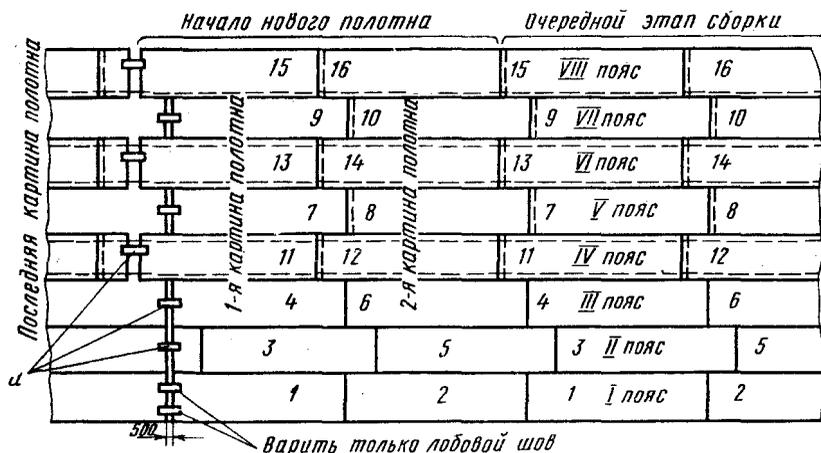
Схема сборки первой и второй картин полотнища:
